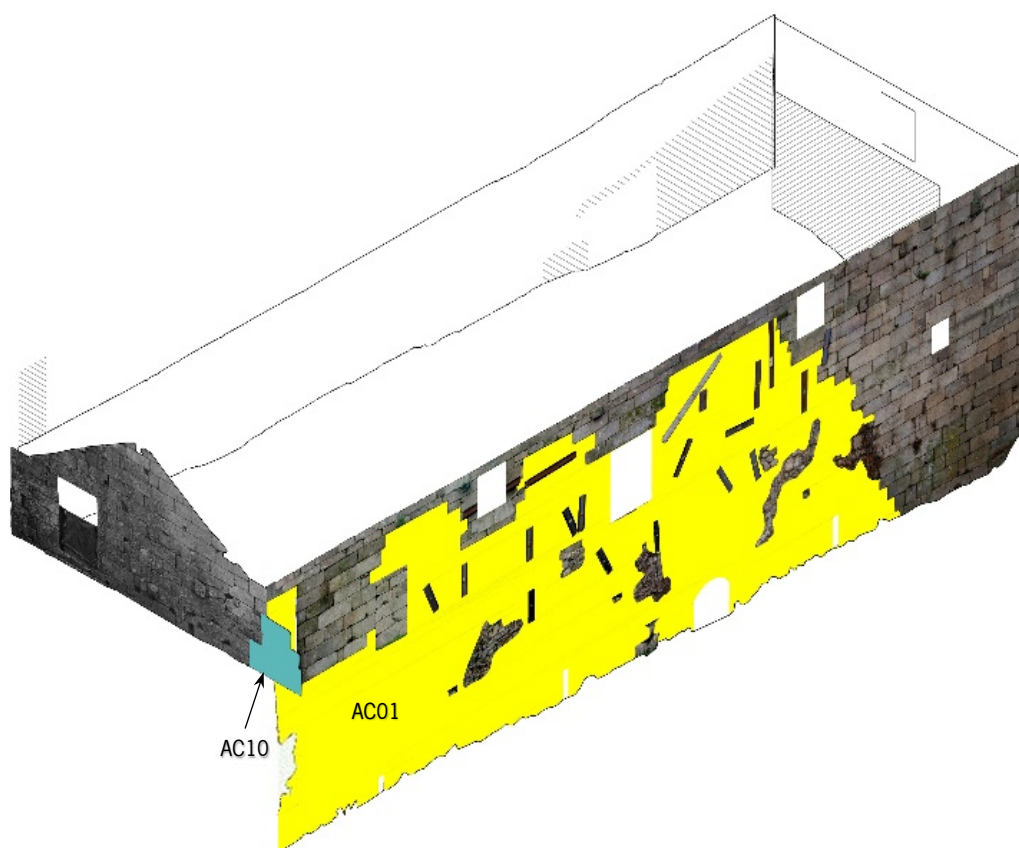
Construção da parede Norte AC01 e cumhal Nordeste do edificado AC10 vista perspectivada de Nordeste.
